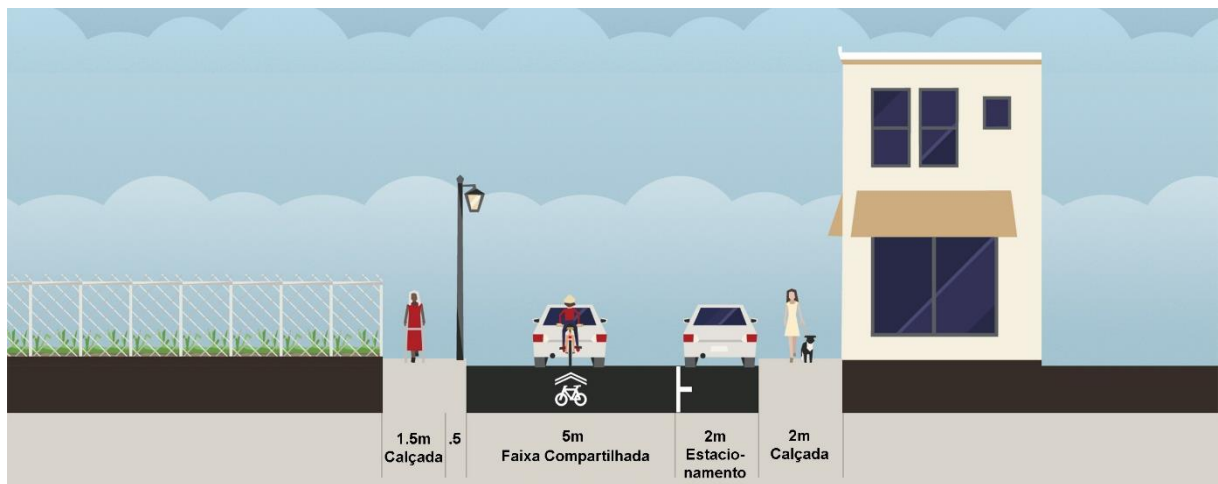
Seção tipo pista de aproximadamente 10 metros
